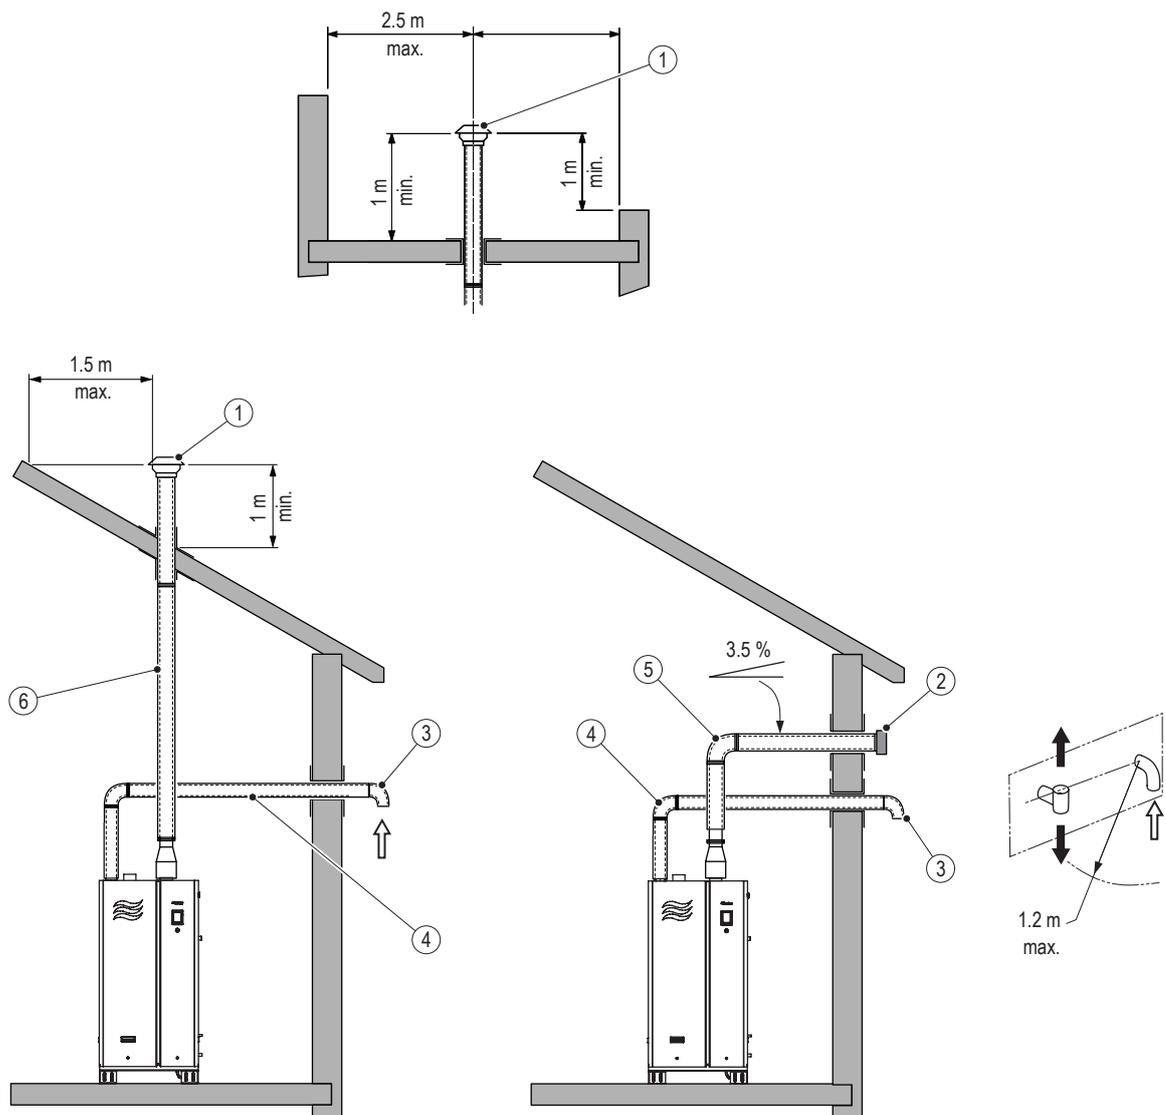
Type C53 Abgasabführung für raumluftunabhängige Installationen
